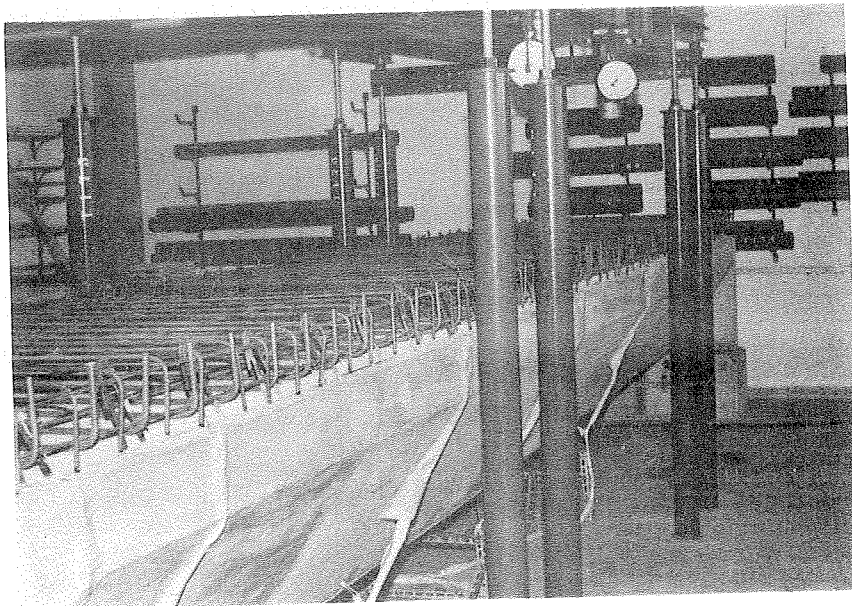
EXECUÇÃO DA LAJE COLABORANTE
